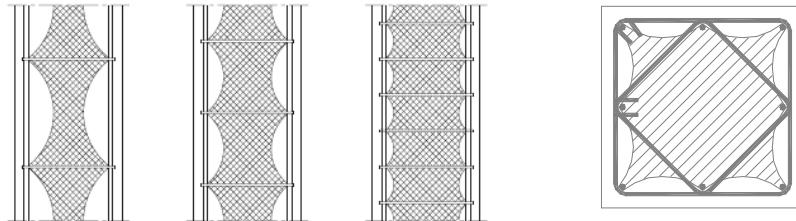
Esquema da redução do volume de betão confinado em função dos espaçamentos das armaduras transversais
